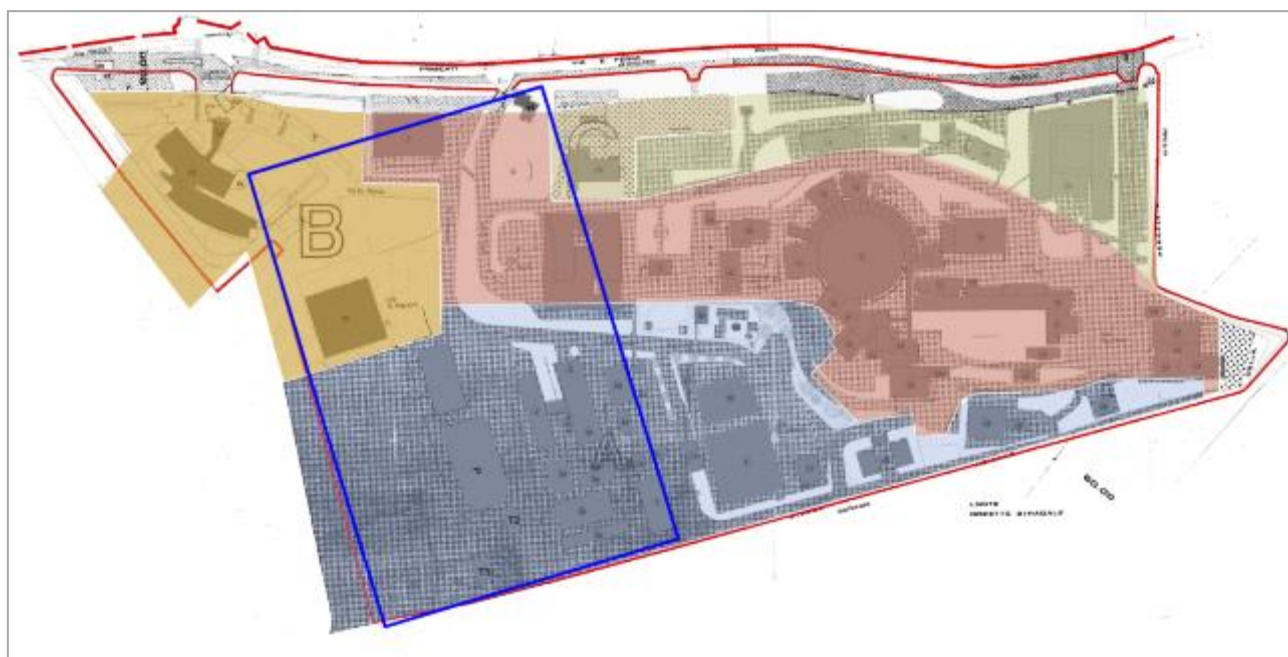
Sovrapposizione della planimetria stato di fatto dei LNF-INFN con la zonizzazione prevista dal PP e con l'individuazione dell'area di intervento.
